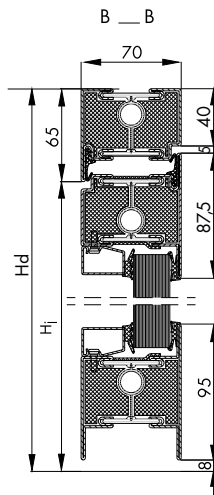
Coupe verticale d'une porte coupe-feu à un battant EI 60 dans le système Jansen Janisol C4.
